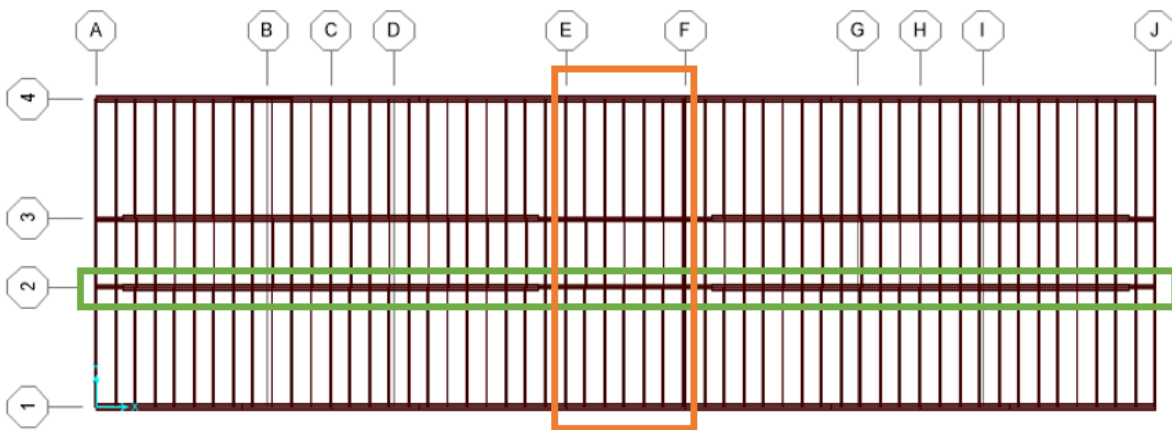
Vista en elevación para Steel Framing, eje longitudinal exterior.
